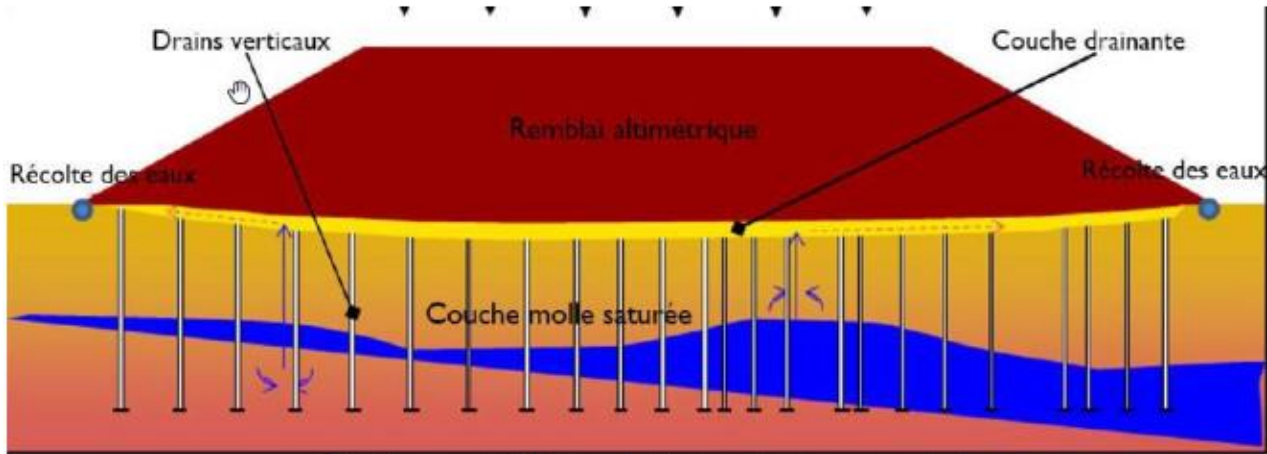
Principe consolidation du site par drainage vertical (source : Ingerop)
